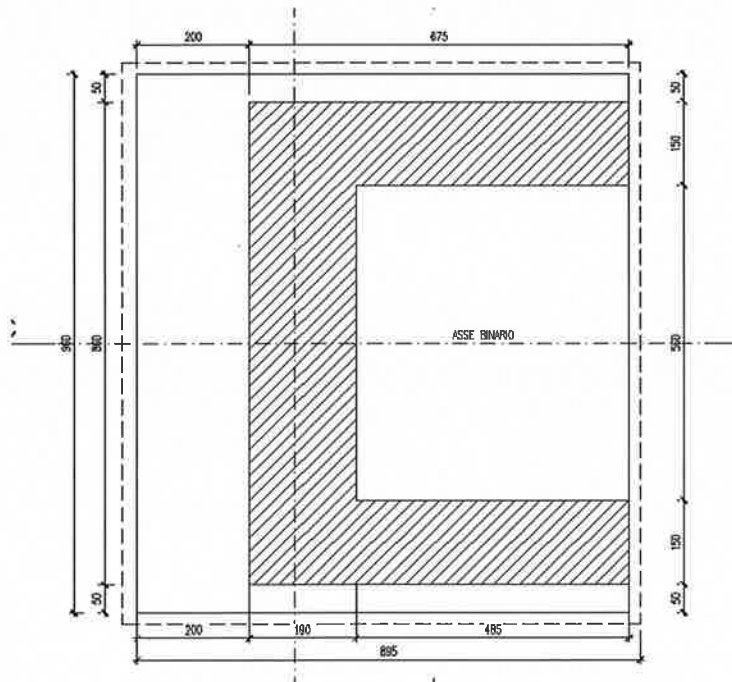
Pianta fondazione spalla B Bauladu VI02
